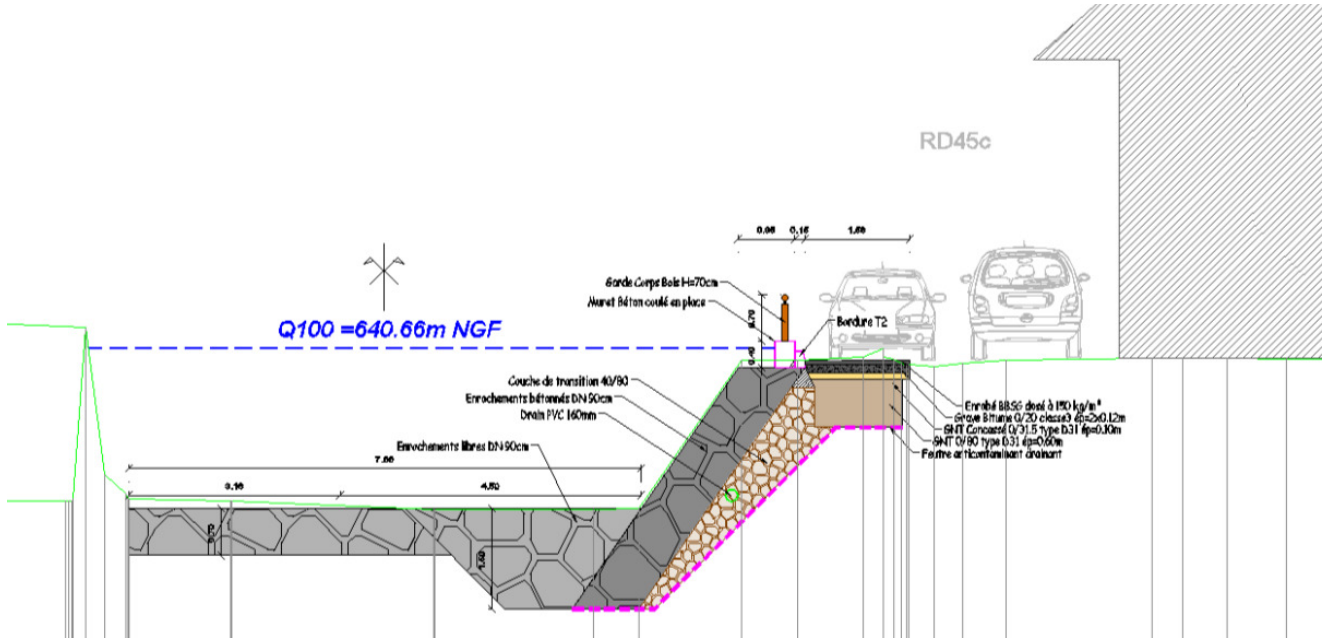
Coupe-type de l'aménagement - Guiers vif amont
